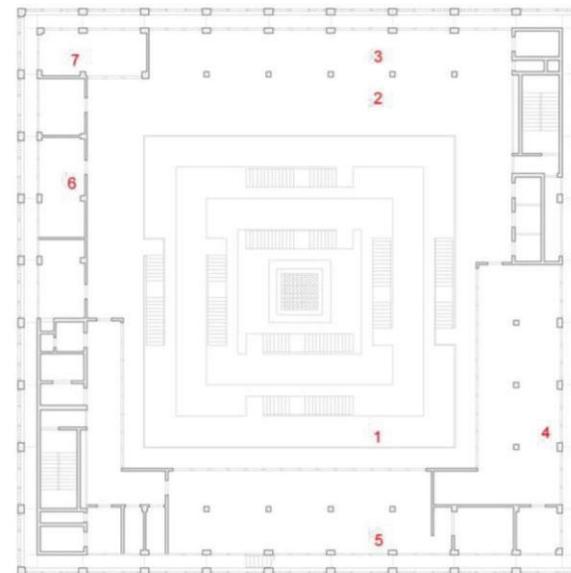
Bibliothek am Mailänder Platz, Grundriss
